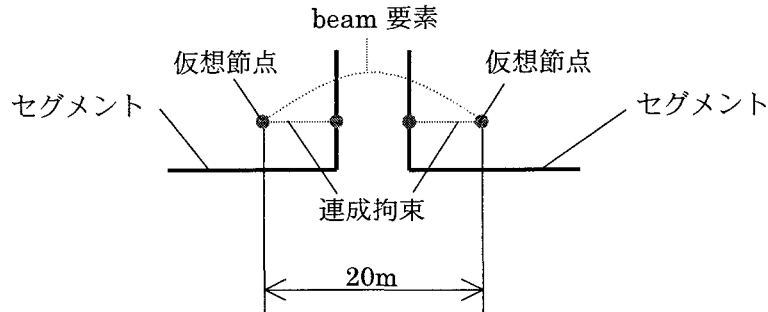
セグメント結合部 M20 ボルト想定 beam 要素
